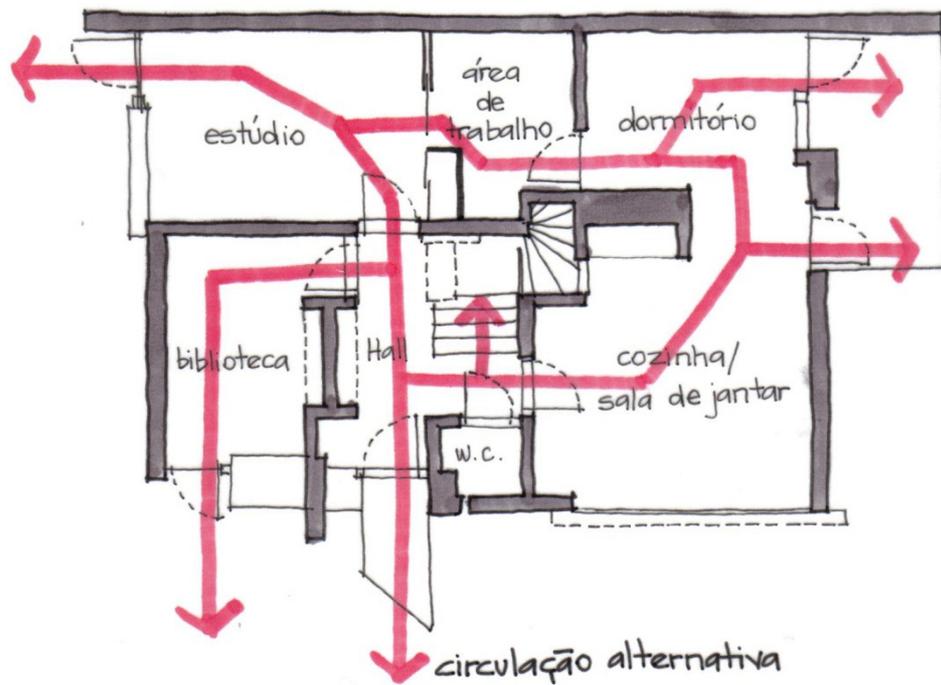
Planta do primeiro pavimento da Casa Rietveld Schroder.
